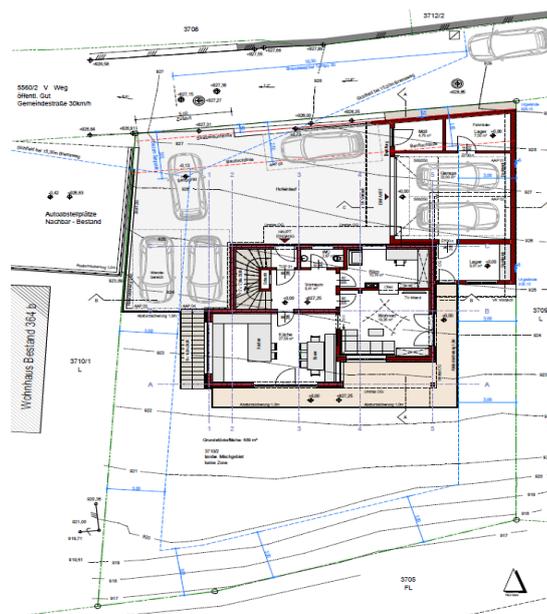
Grundriss Erdgeschoß des geplanten Bauvorhabens seitens des Planungsbüros Zimmermann & Co GmbH mit der Projektnummer 22-041 und dem Plandatum 01.05.2022 (ohne Maßstab)
